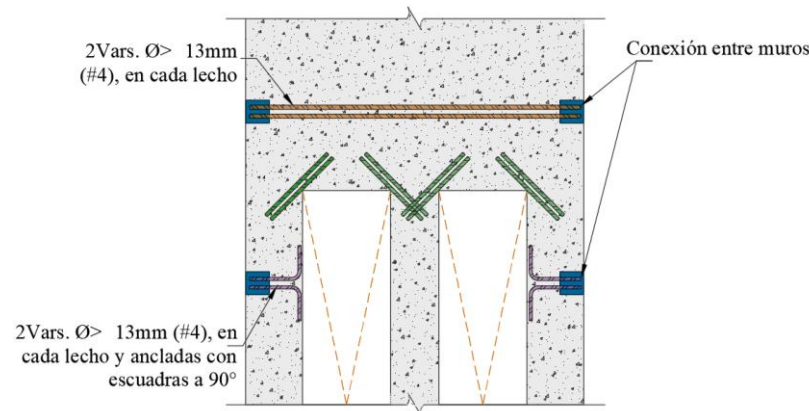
c – Refuerzos horizontales en las zonas de conexión lateral con otros paneles
